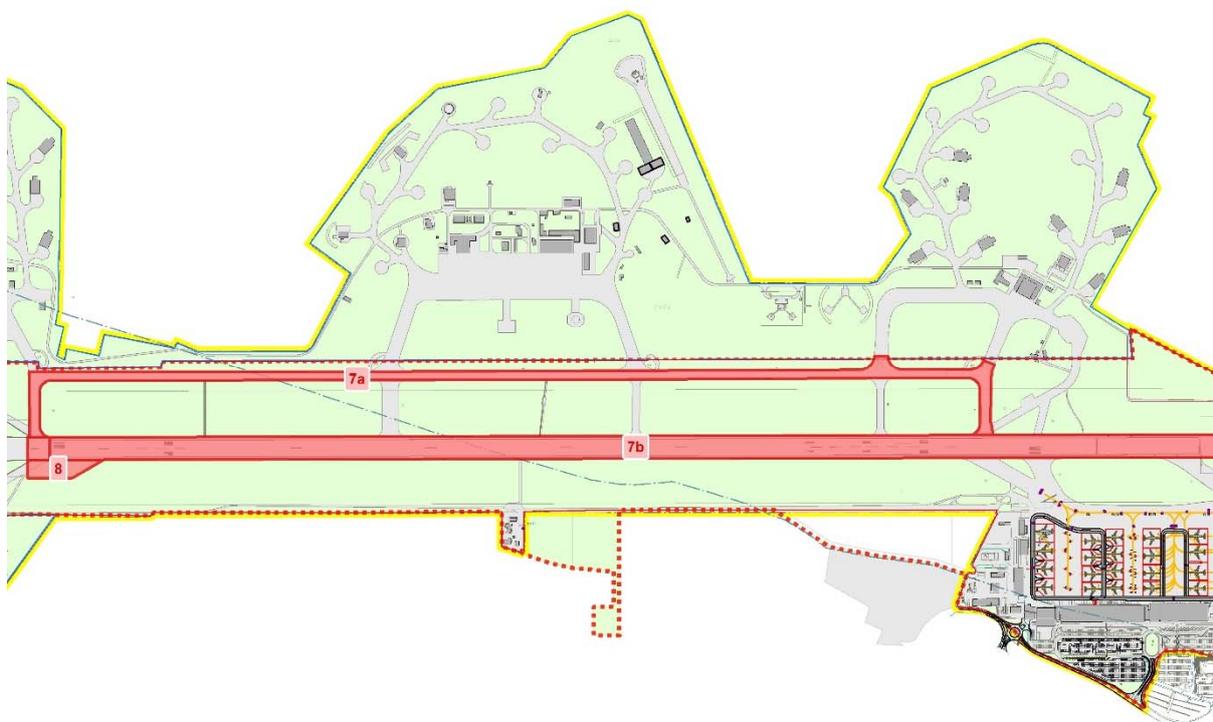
Interventi n. 7a, 7b e 8 – Riqualifica taxiway, pista e nuovo turnpad in testata 04.
